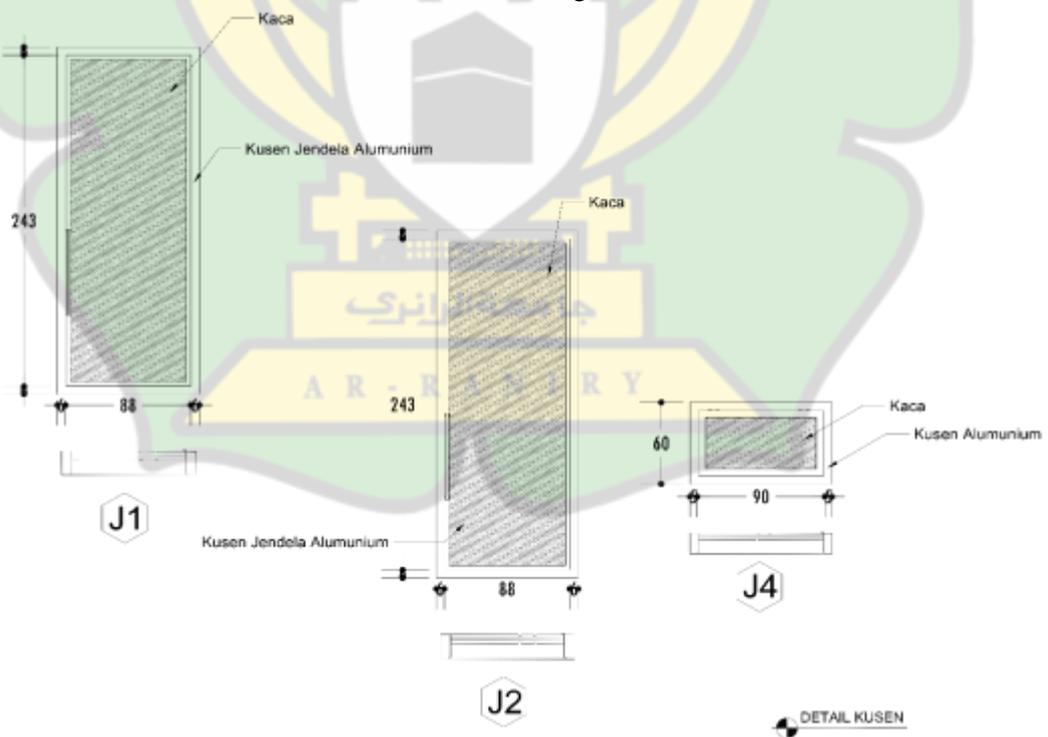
17 Denah Rencana Kusen Asrama Lantai 1
